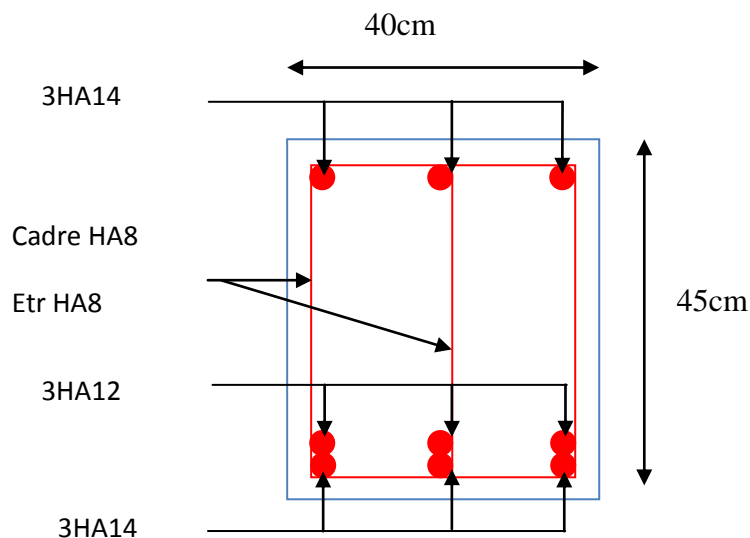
Schéma de ferrailage de la poutre brisée.
